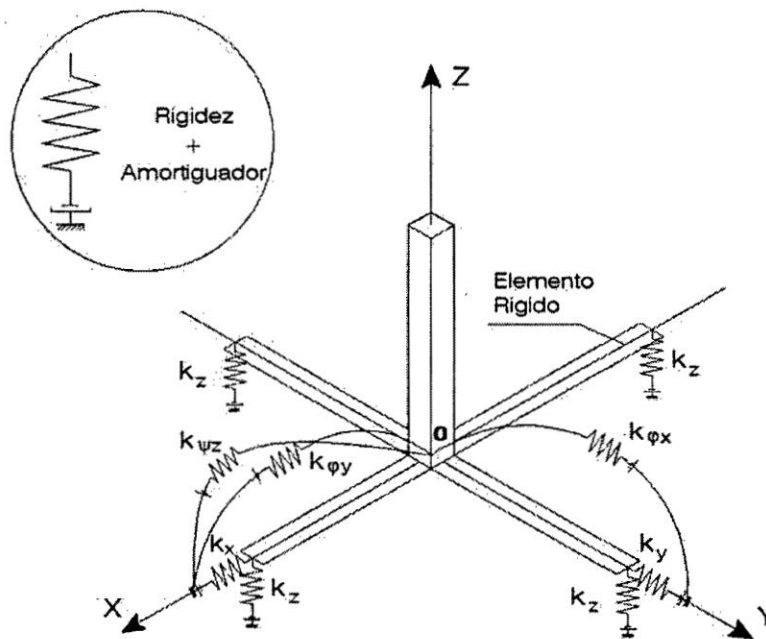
Esquema espacial de Cálculo de la cimentación tipo zapata aislada.
